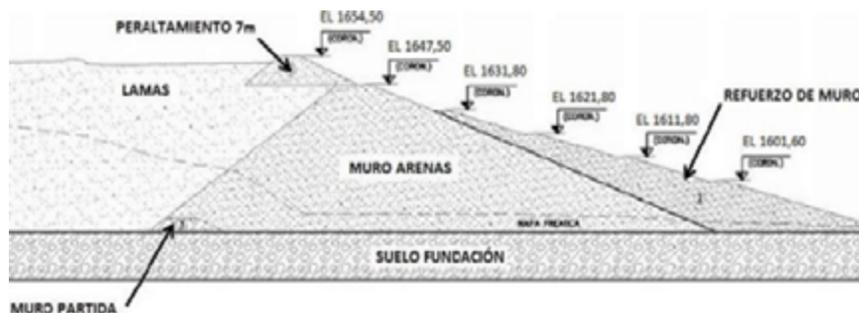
Sección muro 2 del Depósito Barahona 2
